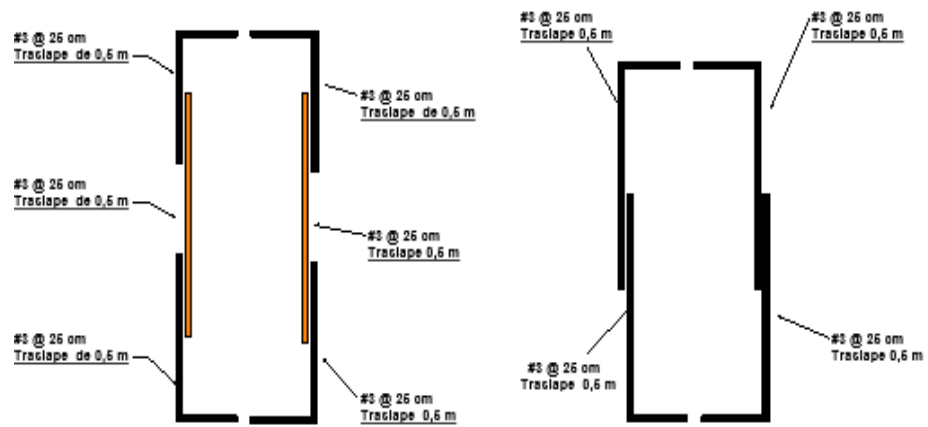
Diagrama Constructivo de Losa de Concreto Reforzado
